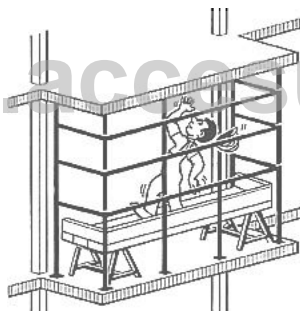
Cerramiento perimetral por medio de elementos verticales y horizontales
